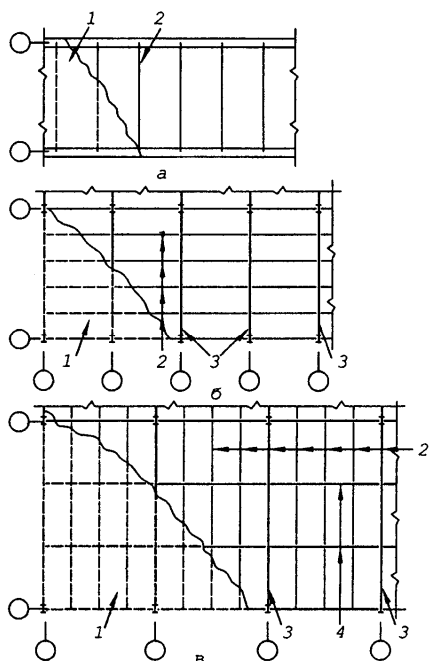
Типи балкових кліток: а – спрощений; б – нормальний; в – ускладнений; 1 — настил; 2 — балки настилу; 3 – головні балки; 4 – допоміжні балки
